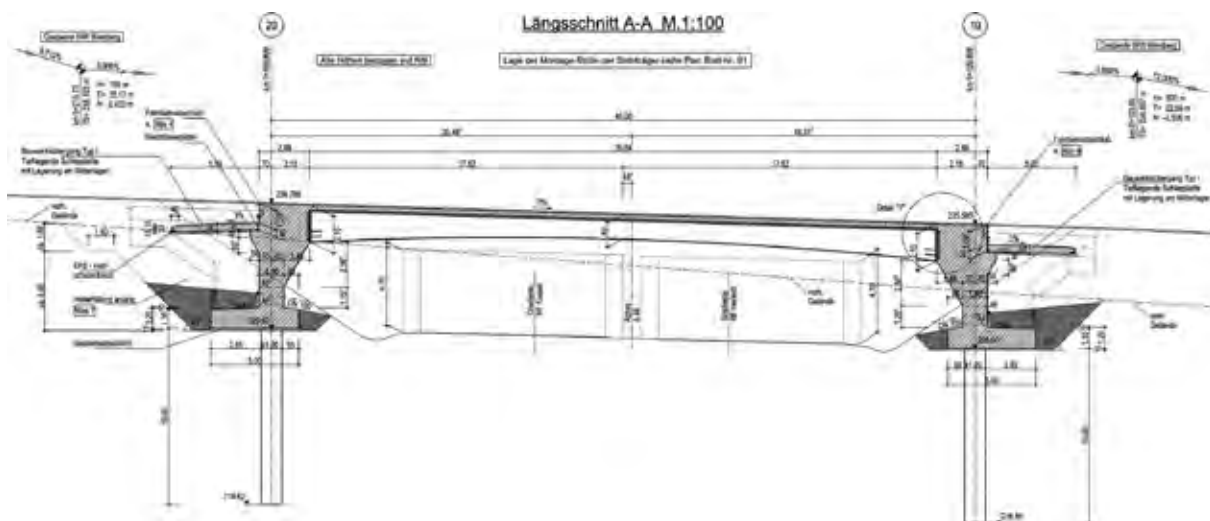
Bauwerksplan – Längsschnitt © DEGES
